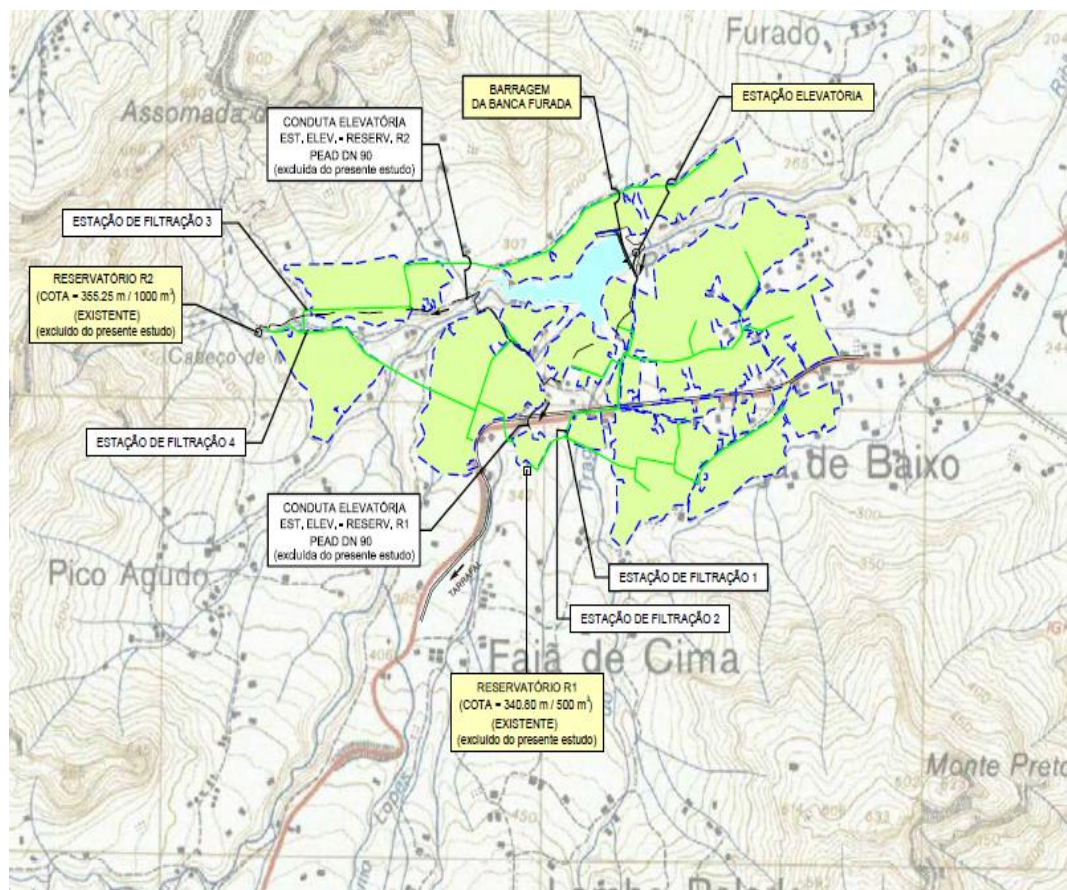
Planta do perímetro de rega da barragem da Banca Furada. (Fonte TPF PLANEGE e AGRO GES, 2014).
